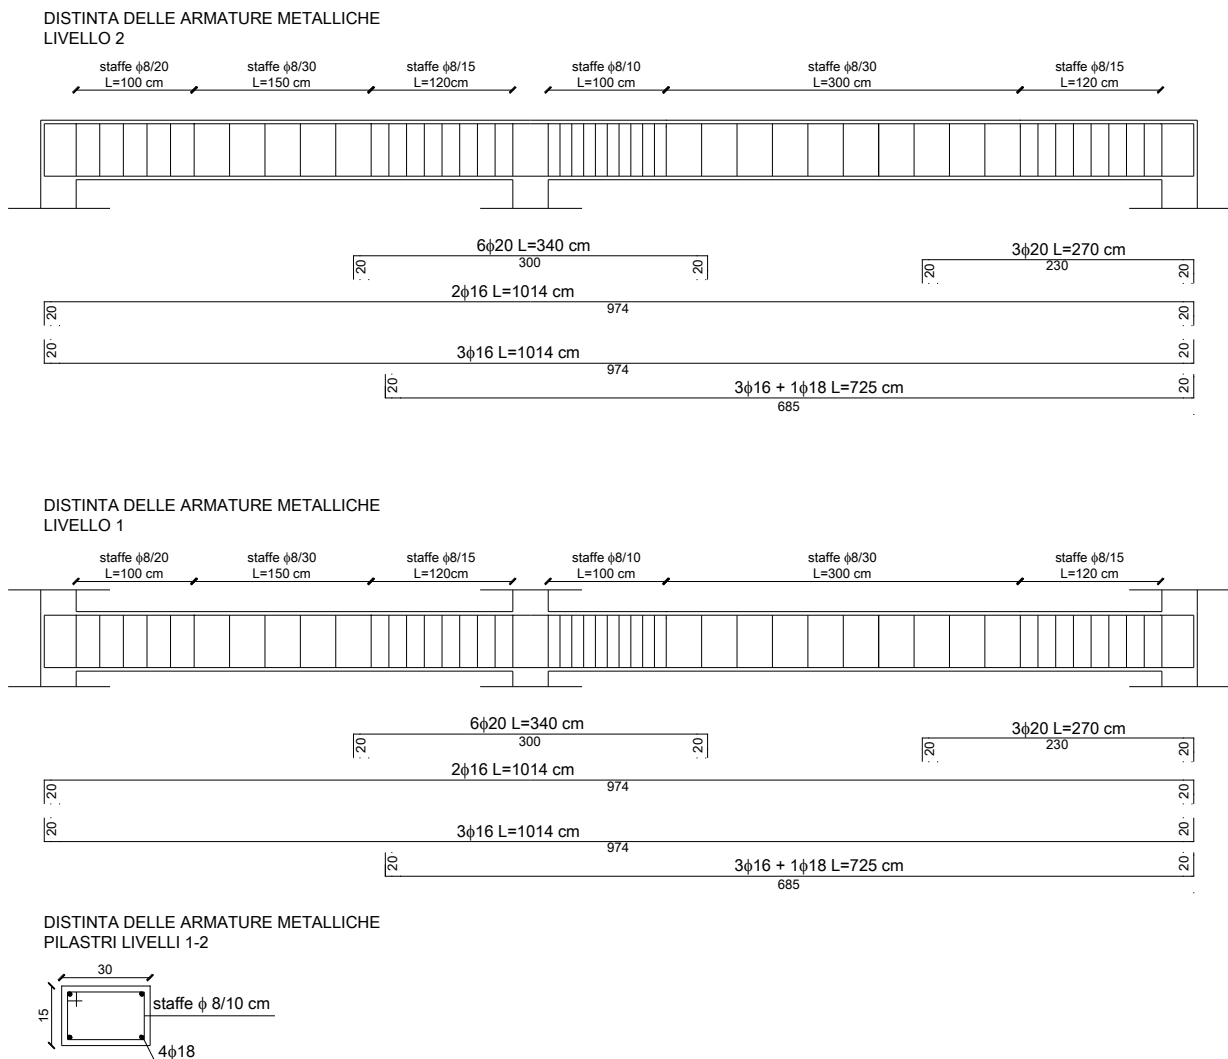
Distinta delle armature degli elementi strutturali.
